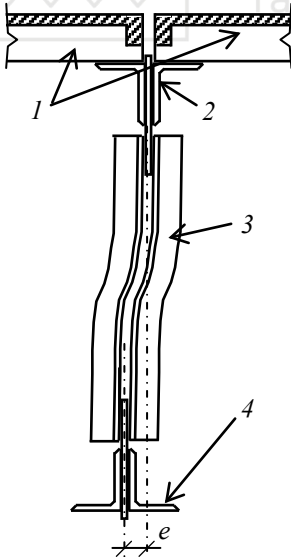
Зміщення осей верхнього або нижнього поясу від проектного положення: 1 – плити покриття; 2 – верхній пояс ферми; 3 – елемент решітки ферми, що має викривлення; 4 – нижній пояс
